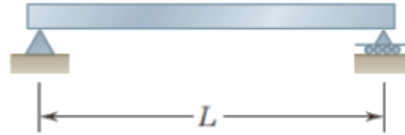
Carga distribuida en viga simplemente apoyada .(NEC-SE-DS, 2015)
